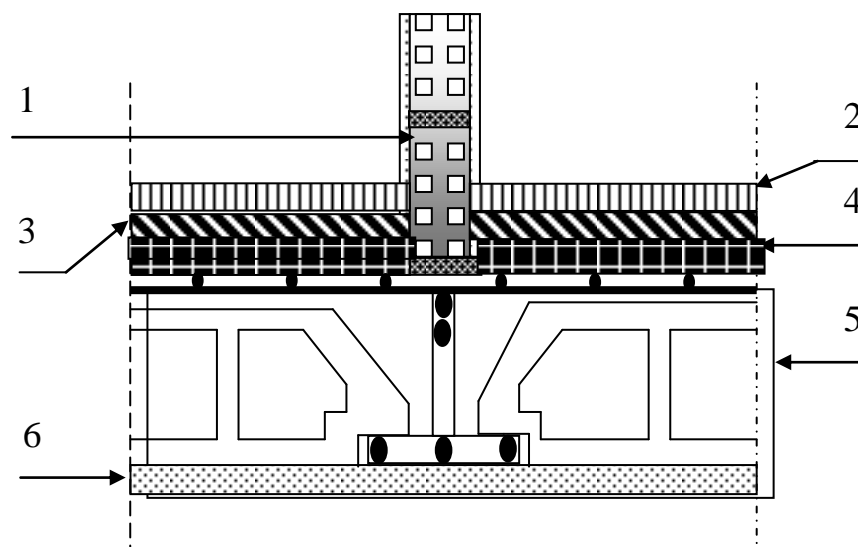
Coupe du plancher de la terrasse à corps creux
